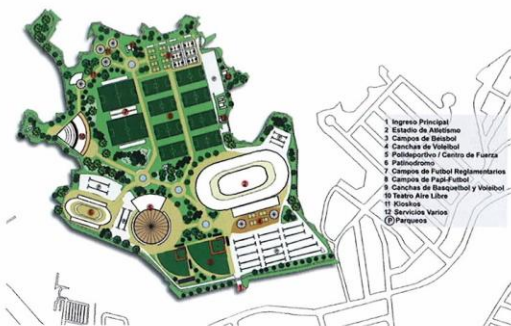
VISTA EN PLANTA DEL CONJUNTO Fuente: Internet
